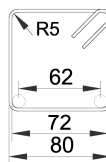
Dimensionado de los estribos de la viga sin muesca. Dimensiones en mm.
